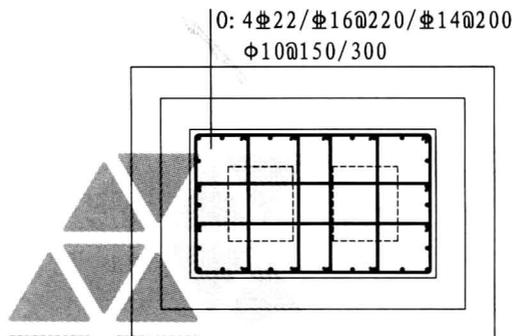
双高杯口独立基础杯壁配筋示意
